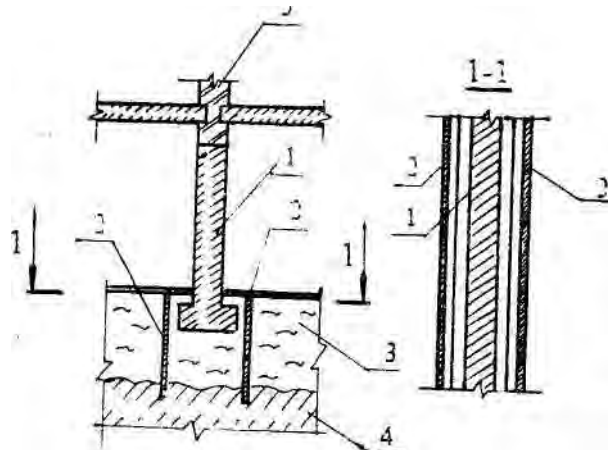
Улаштування шпунтових стінок із прокатного металу: 1 - існуючий фундамент; 2 - стінки із металевого шпунту; 3 - несучій шар (слабкий ґрунт); 4 - підстиляючий шар (міцний ґрунт); 5 - цегляна стіна.
